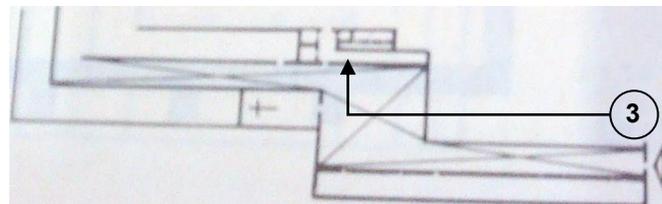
Gráfico del levantamiento Arquitectónico en planta de la Fachada de una de las casas de la antigua Fábrica y parte del acceso (Por el INAH 1984)
